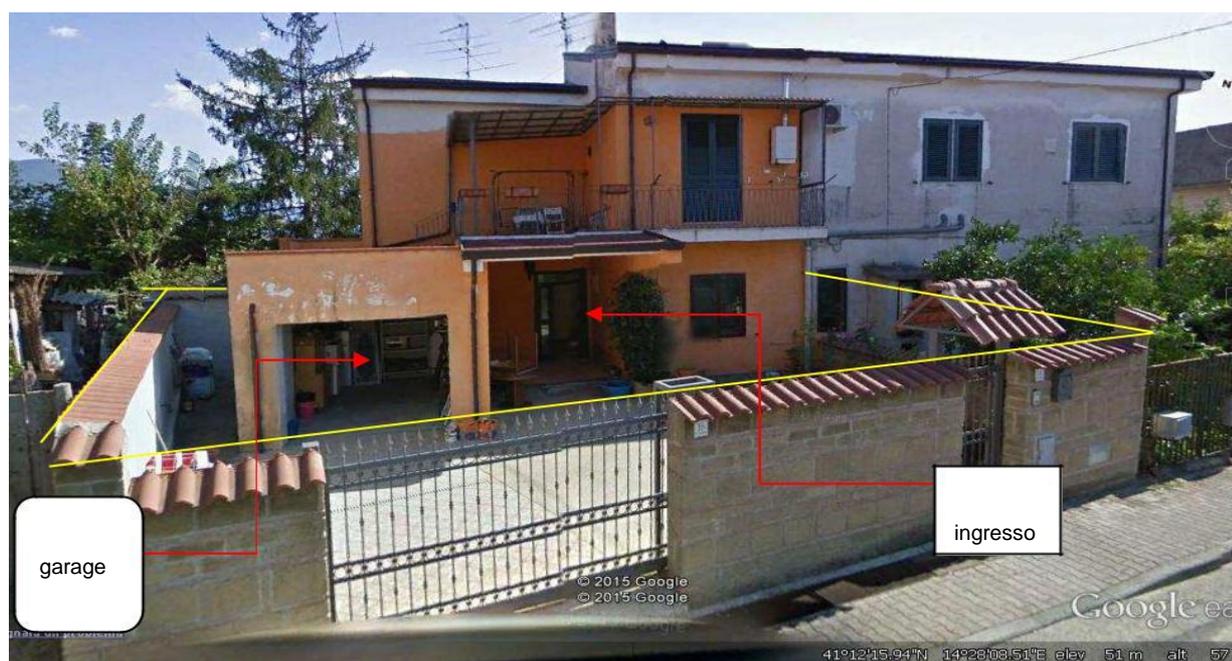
La linea gialla tratteggiata individua la p.lla 496 (corte) oggetto di pignoramento Le linee rosse indicano l'ingresso al piano terra ed il garage entrambi non censiti in catasto.
